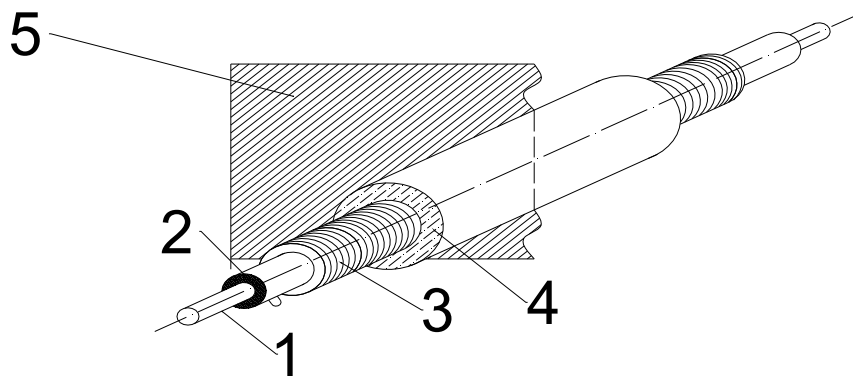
Теплоизоляция узла ввода трубопроводной системы в здания
